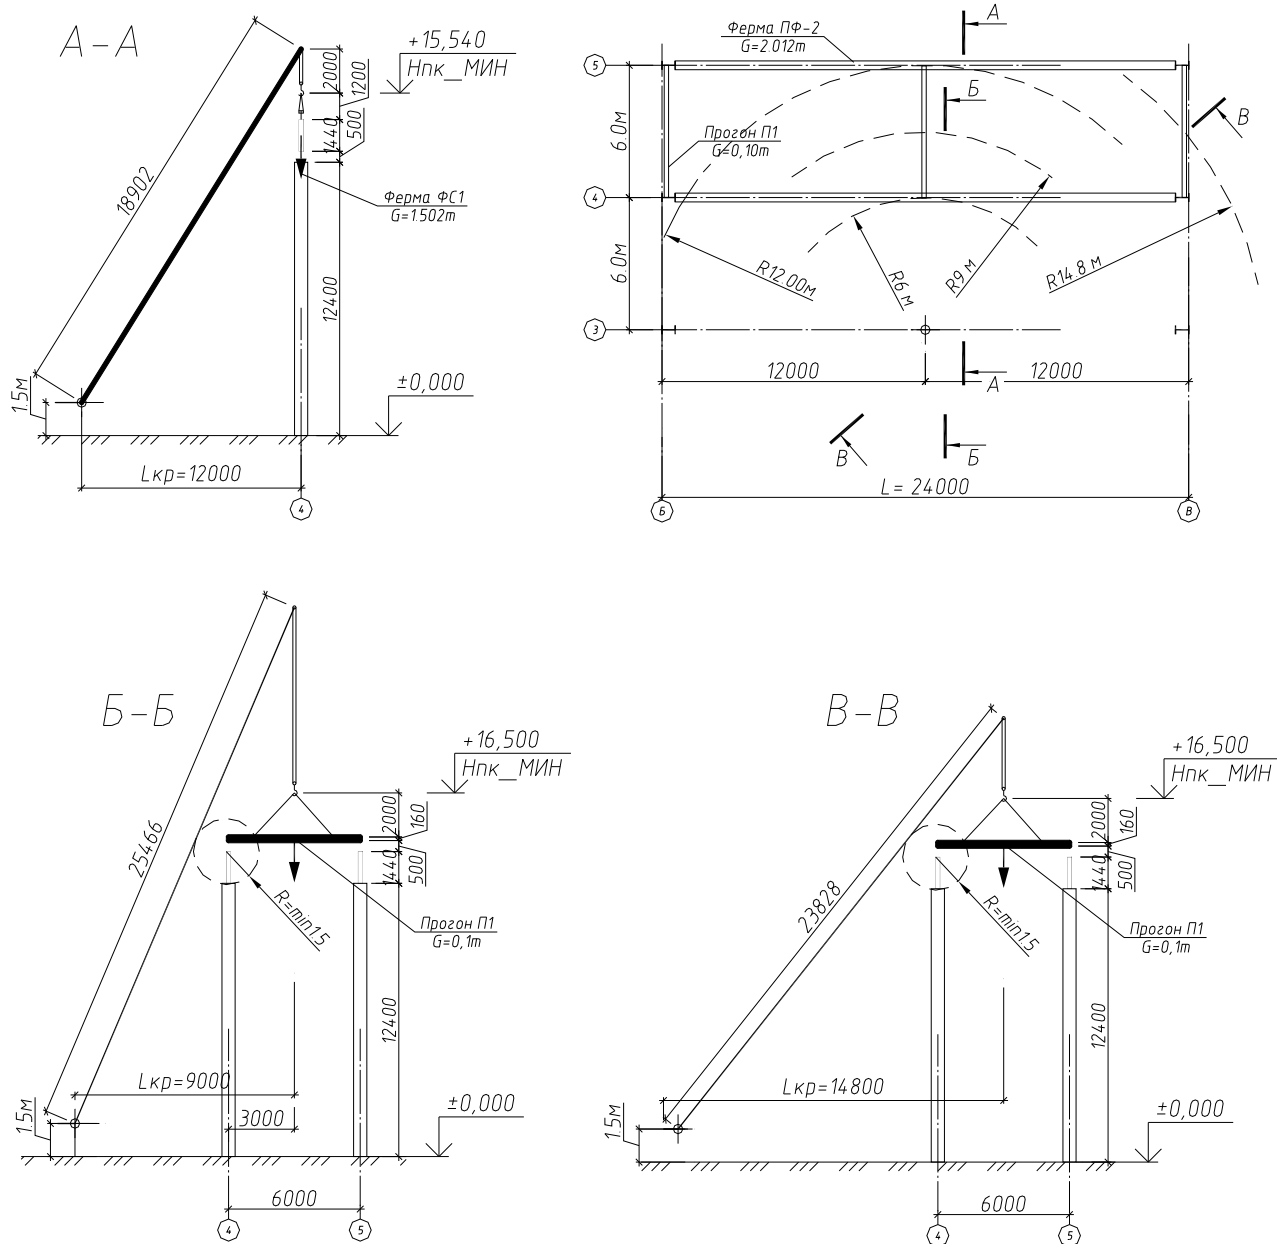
К подбору крана для монтажа элементов покрытия
